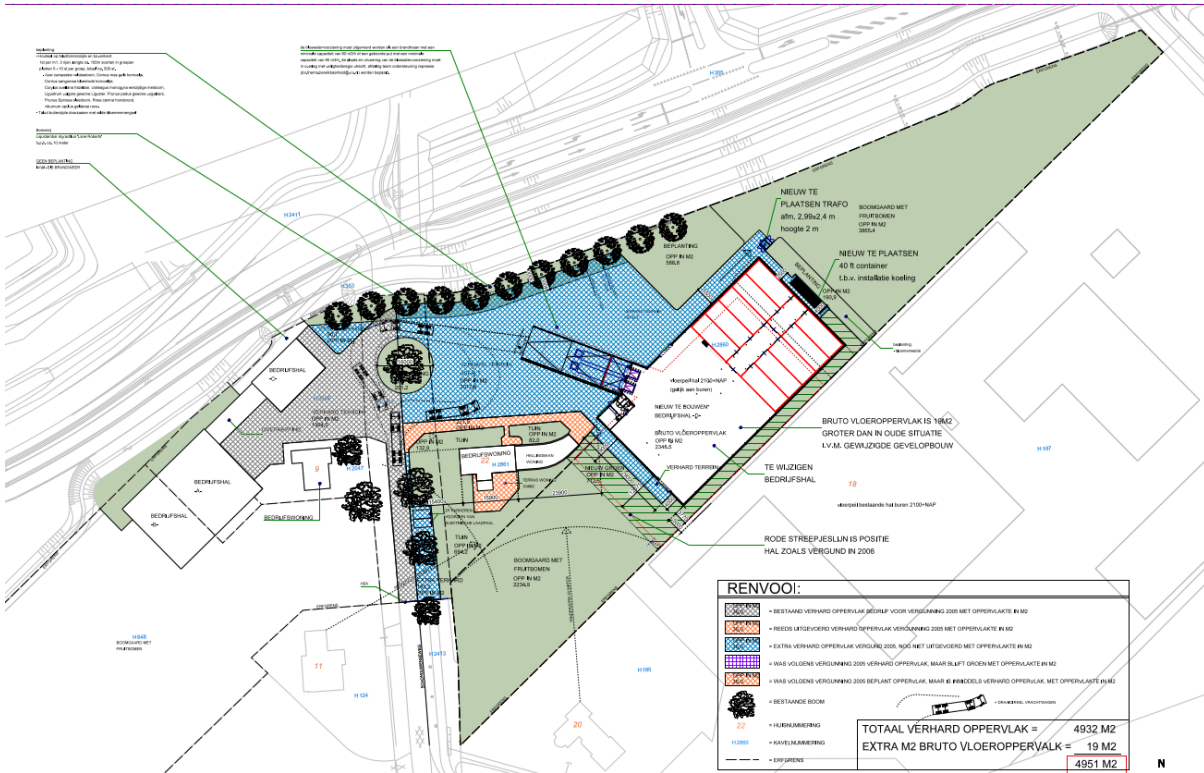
Situatietekening gewenste situatie (bron: Architectenburo Huub van der Zee B.V.).
